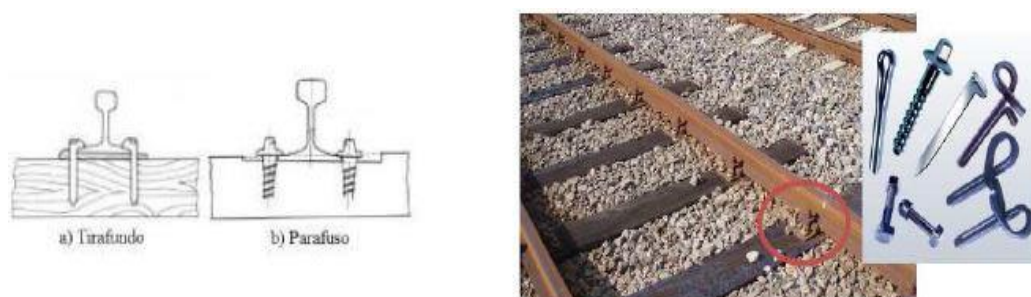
Exemplo de fixação rígida (Fonte: (13))
